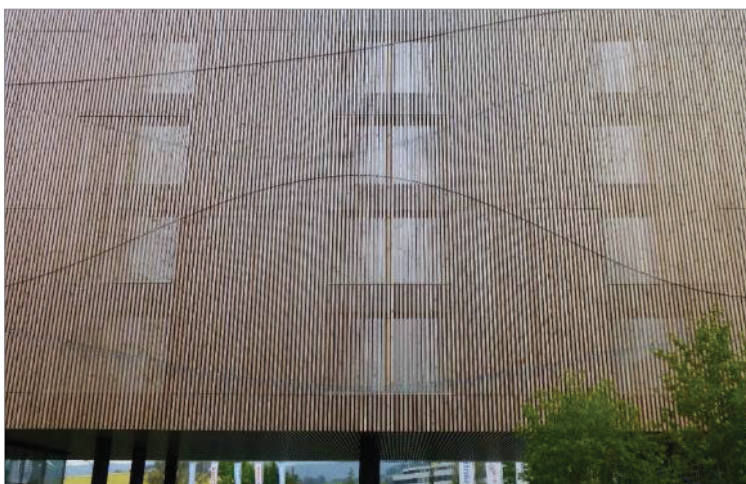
Fassaden mit «offener» Holz-Aussenwandbekleidung. Der Witterungsschutz muss durch die darunterliegende, wasserführende Schicht gewährleistet werden; Hotel Sântispark Abtwil; Carlos Martinez Architekten, Berneck
